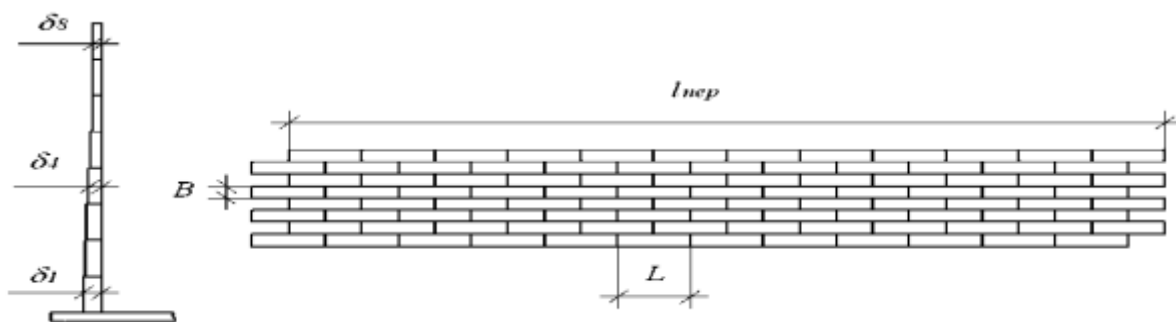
Развертка и сечение стенки вертикального резервуара.
